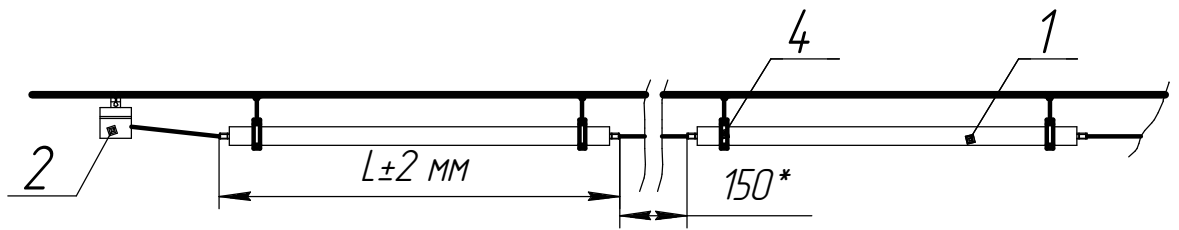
1 - Корпус; 2 - распредел. коробка;
